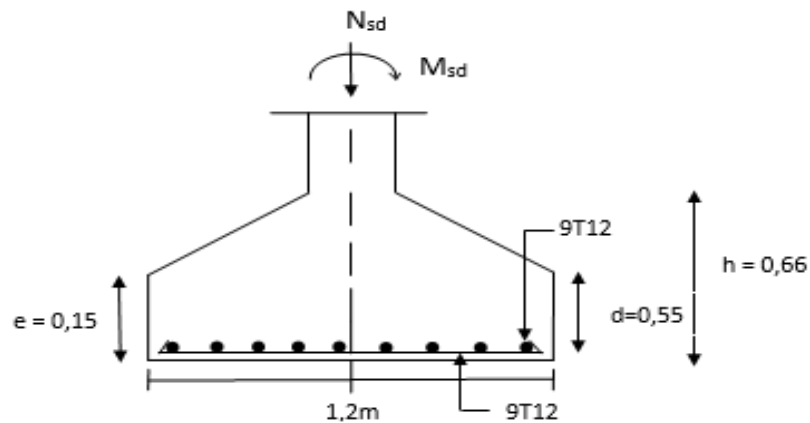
2 : Ferrailage de la semelle intermédiaire
